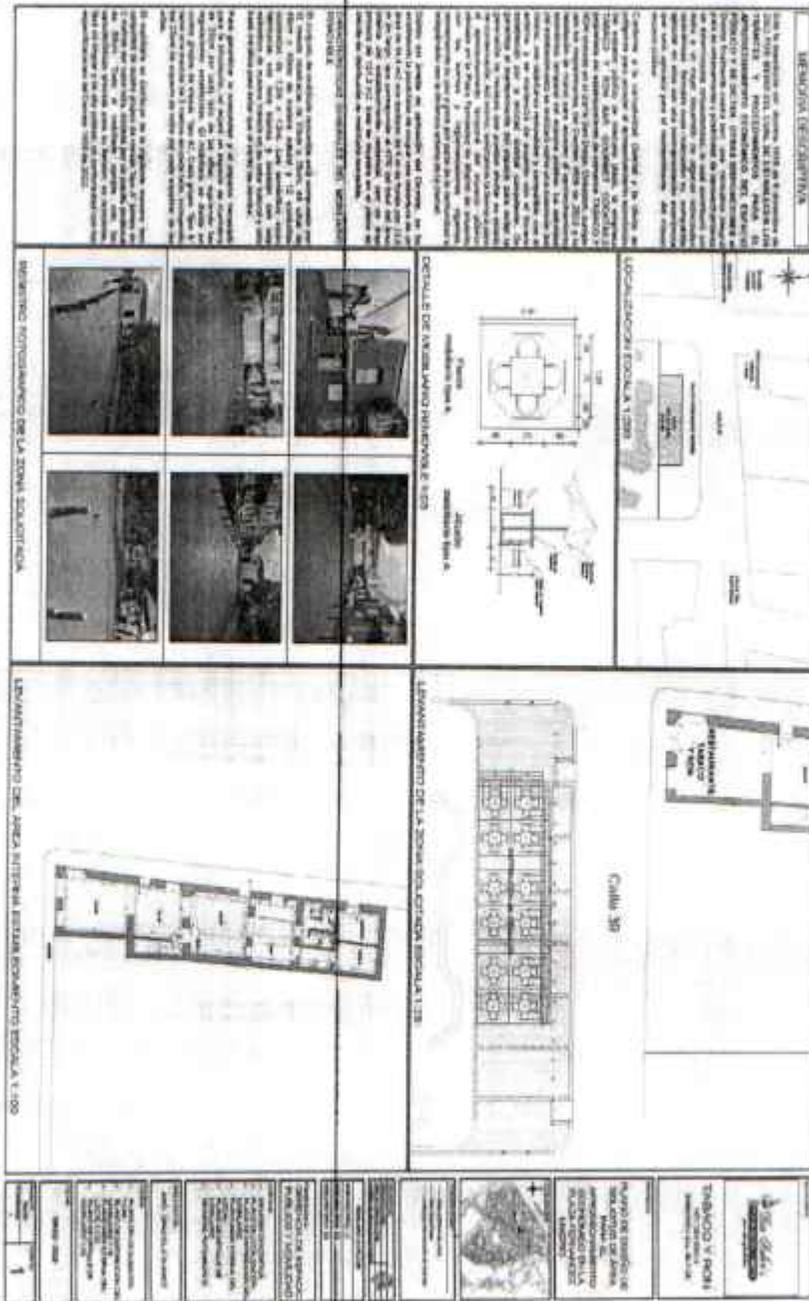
Plano RESTAURANTE TABACO Y RON BAR GOURMET COCKTAILS.
